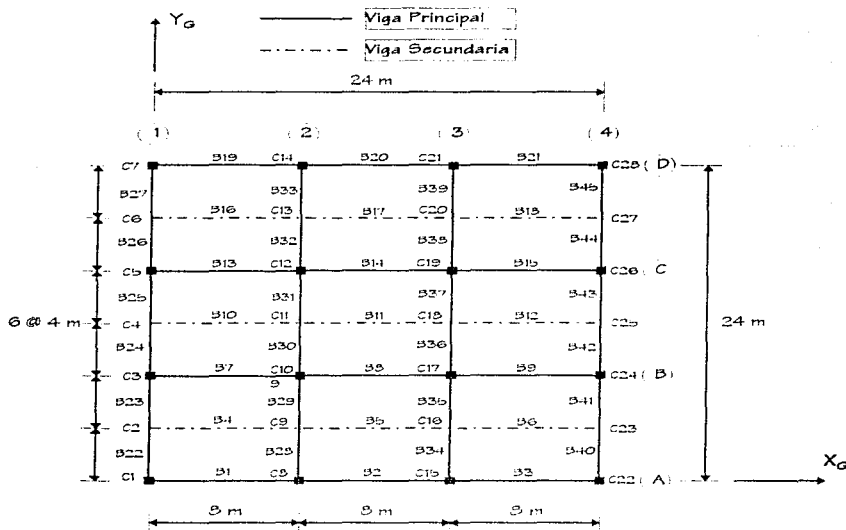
Planta tipo de la estructura con ubicación de vigas y columnas
